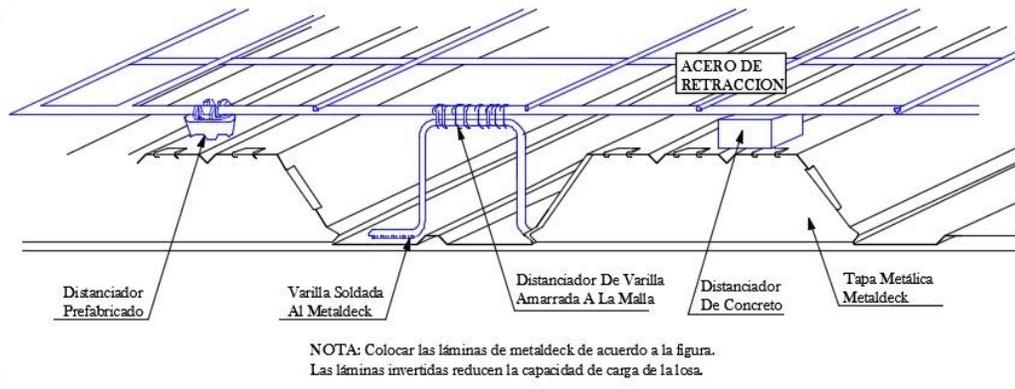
Detalle transversal del sistema de losa con metaldeck
